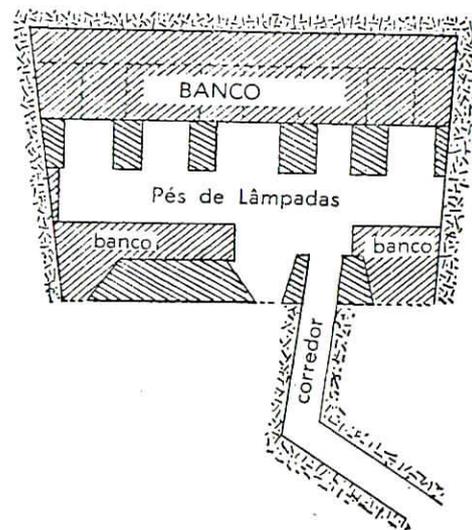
Plano da casa de Angmagssalik (H. B.)
